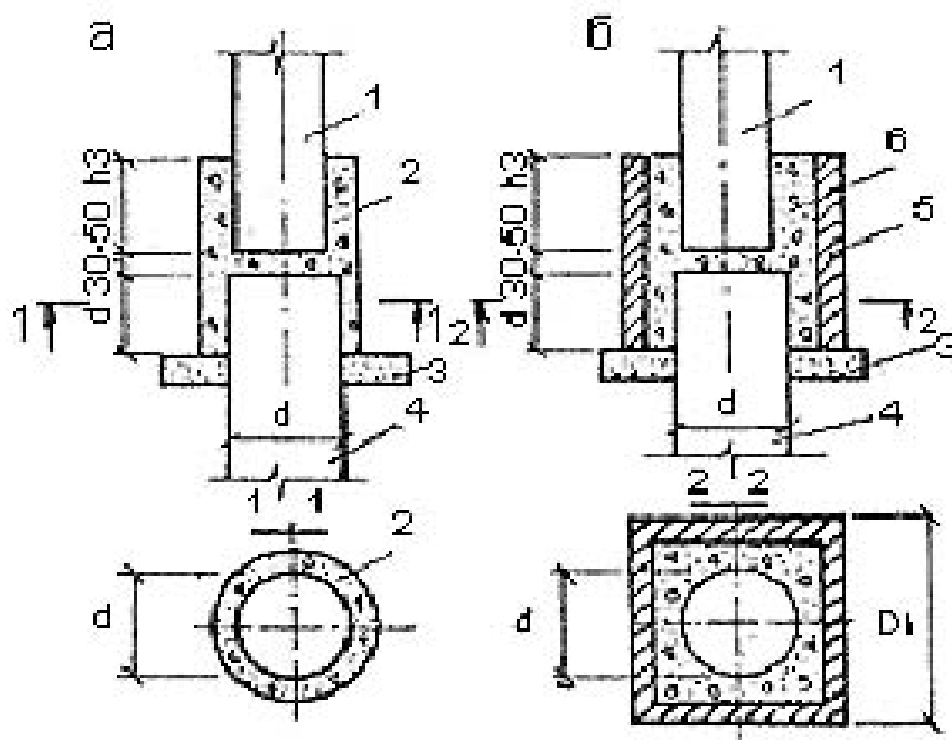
Узел сопряжения колонны с односвайным фундаментом:
